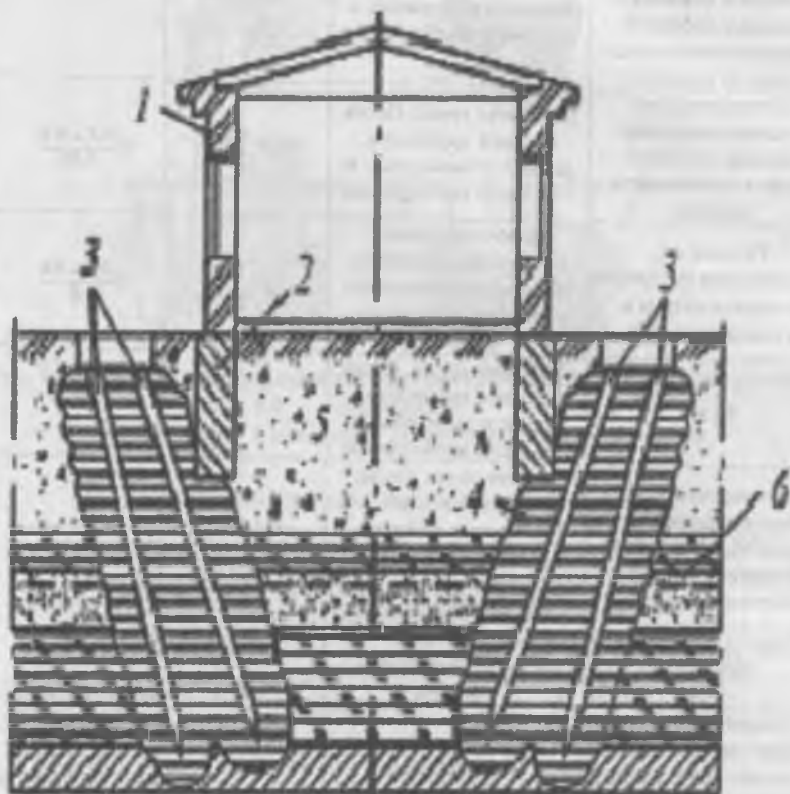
Вариант укрепления основания песчаными сваями:
